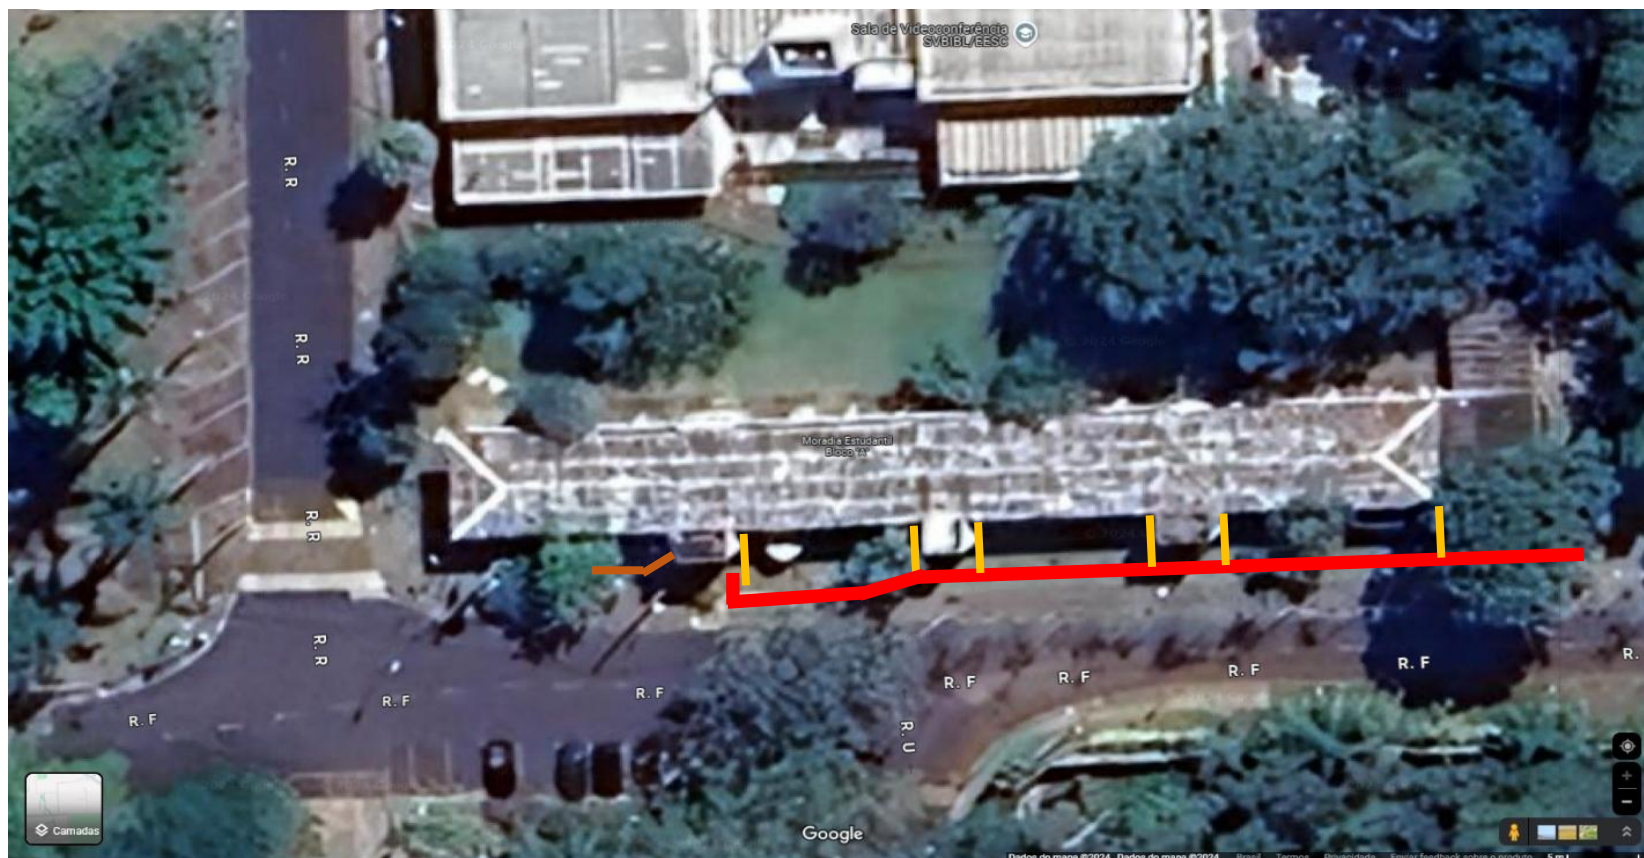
, LEGENDAS:  Canaleta de drenagem “tipo 1” (longitudinal)  Canaleta de drenagem “tipo 2” (transversais)  Canaleta de drenagem “tipo 3” (entrada)
